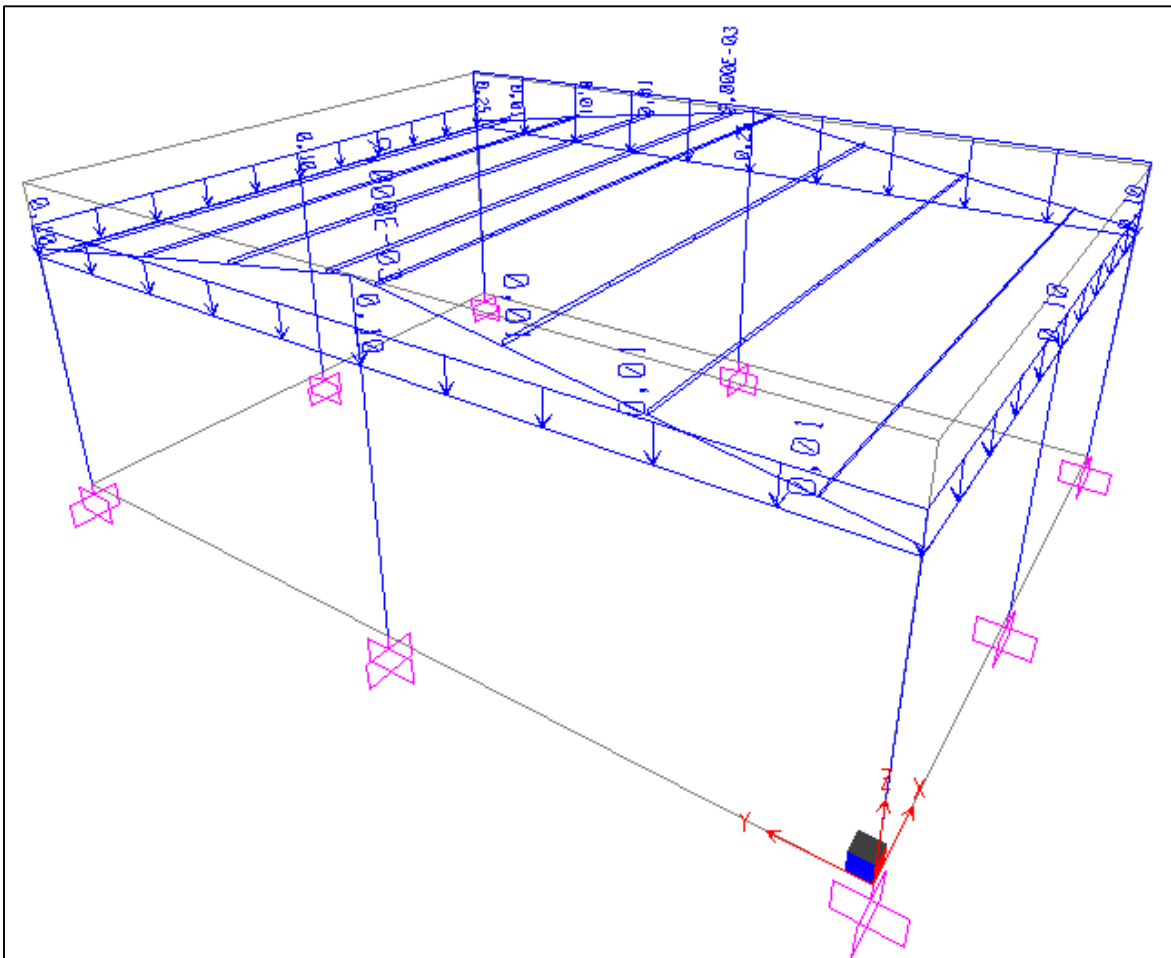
Disposición de cargas sobre la estructura.
